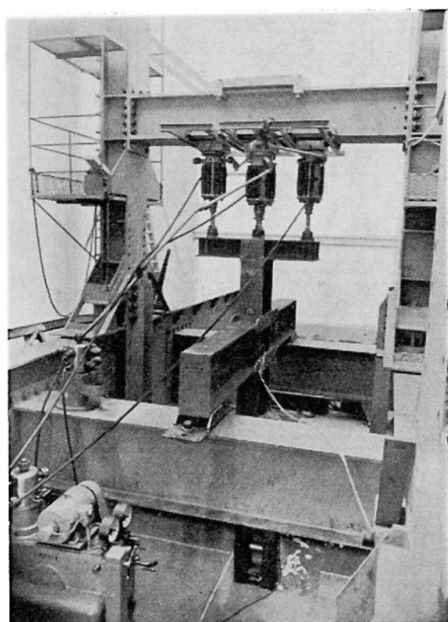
Essai assemblage mixte: boulons HR + barrettes d'encastrement soudées.
